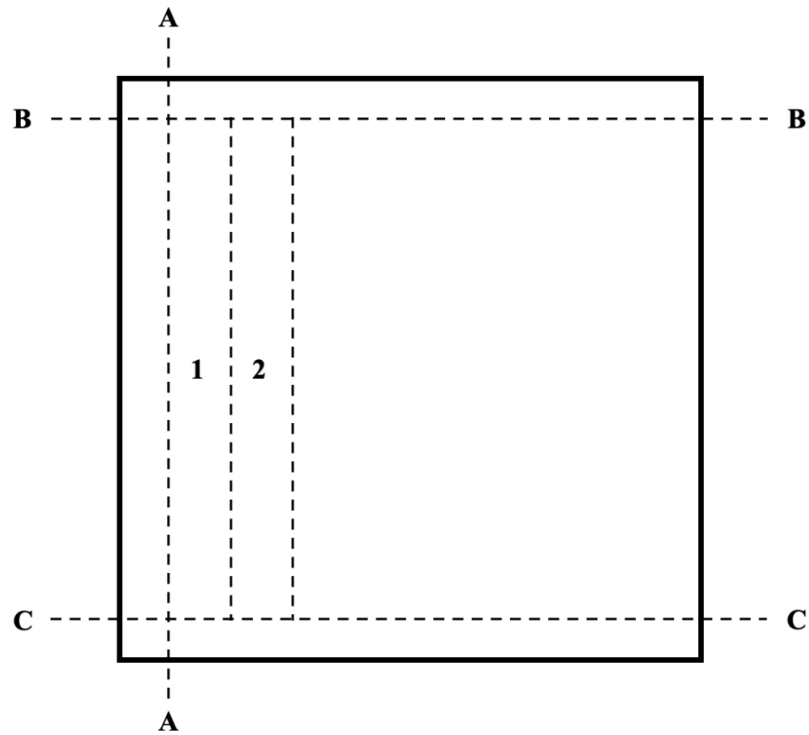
Принципова схема розрізки зразків балочок
